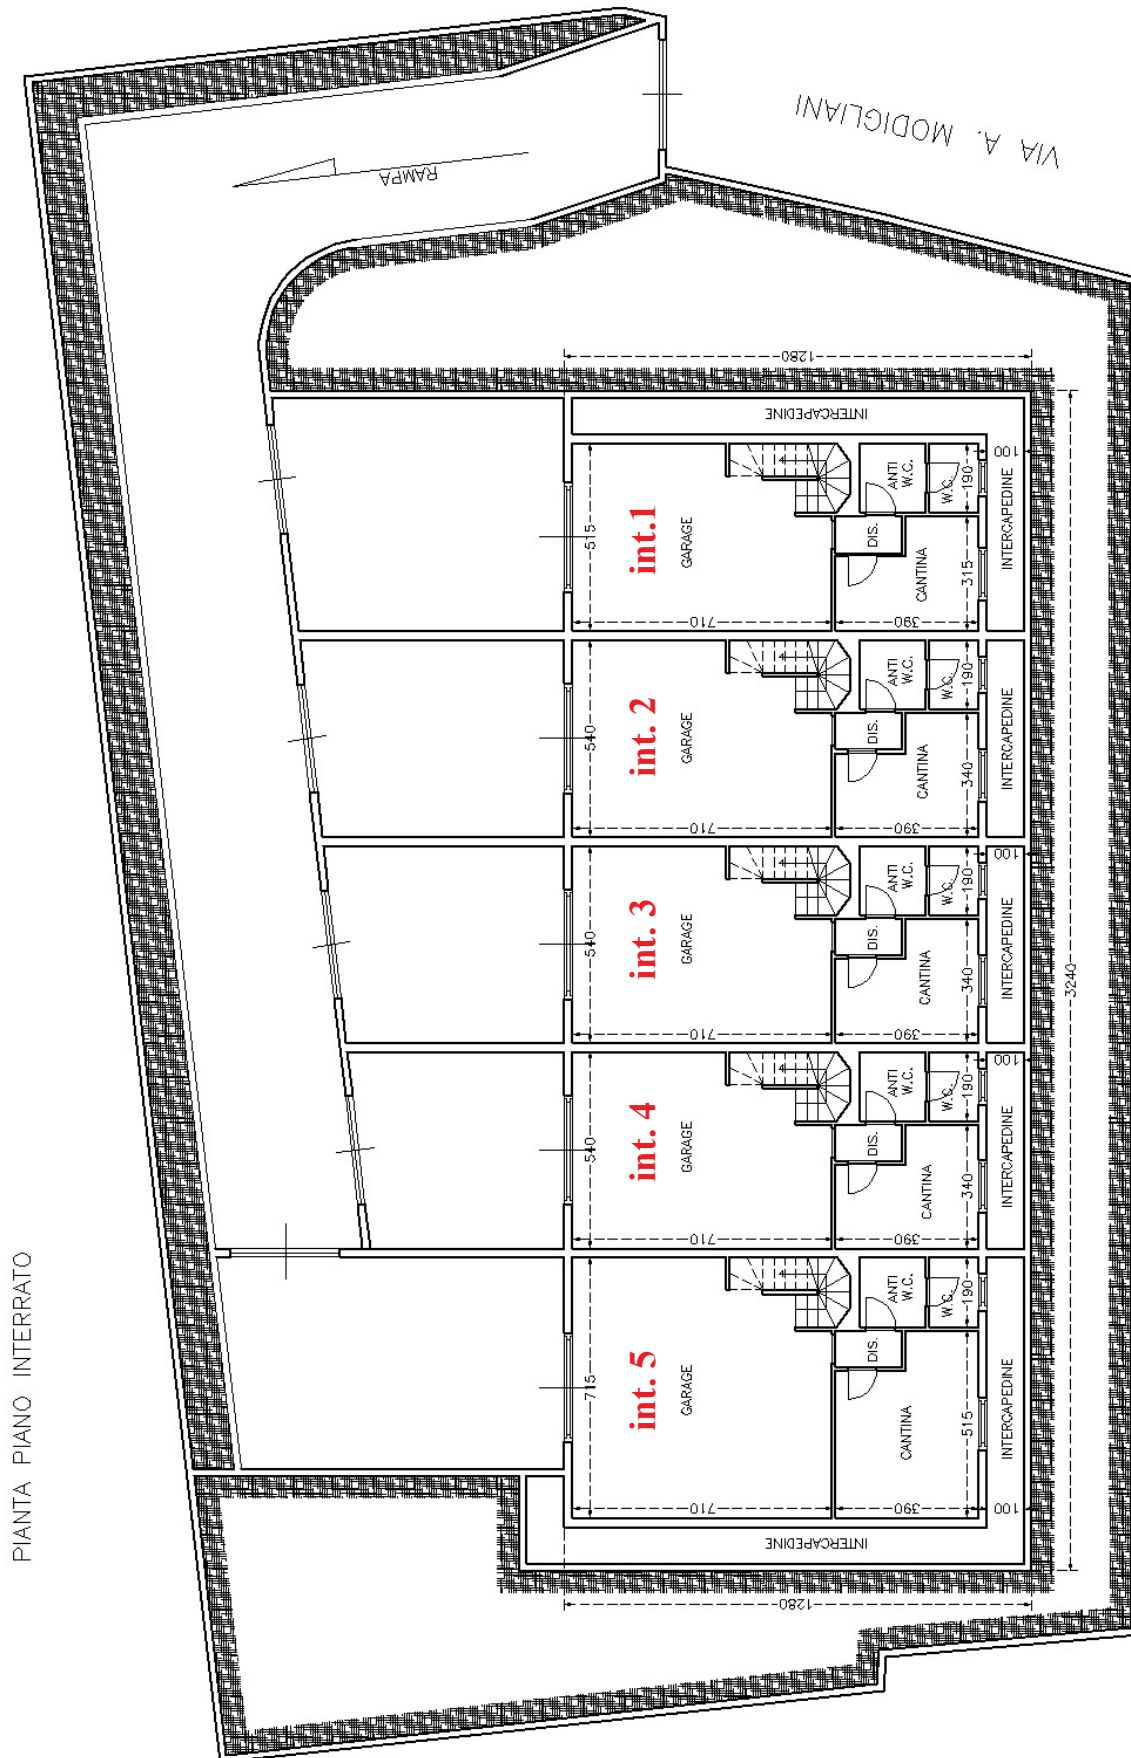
Planimetria del manufatto edilizio
